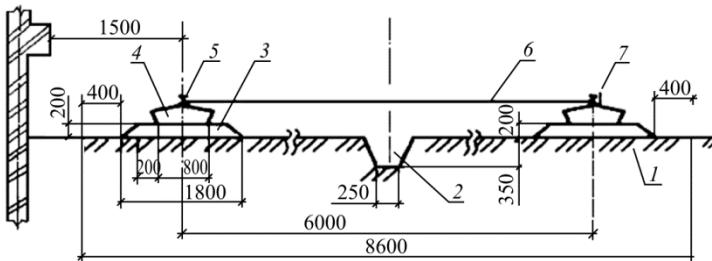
Схема привязки подкрановых путей (МДС 12-61.2012 «Проект производства работ на устройство рельсового пути башенного крана с железобетонной балкой БРП-62.8.3»)
